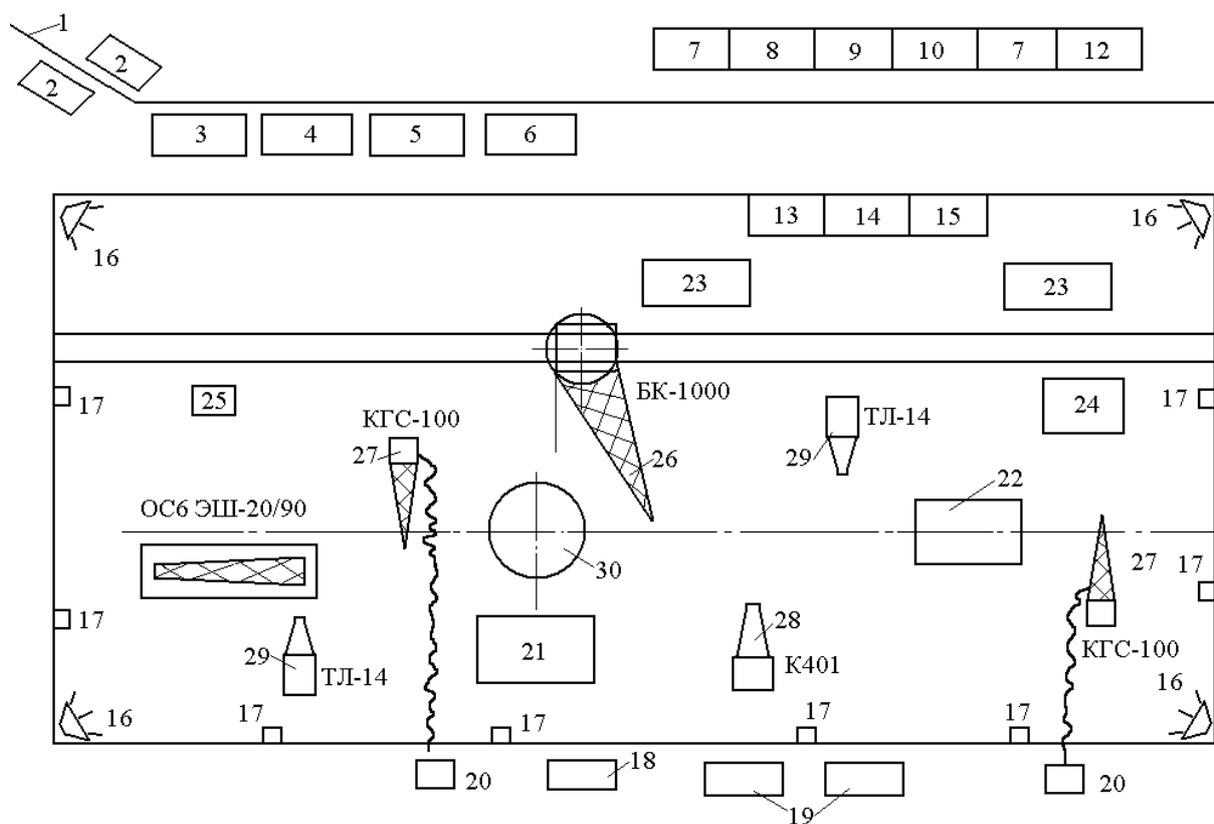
Монтажная площадка Могунского разреза: 1 – ж/д путь; 2 – передвижная котельная; 3 – диспетчерская; 4 – строительное управление; 5, 6 – горные участки; 7 – гараж; 8 – РММ; 9–15 – складские помещения; 16 – осветительные мачты; 17 – сварочные посты; 18 – слесарная мастерская; 19 – складские и бытовые помещения; 20 – электрощитовая; 21, 22 – площадки монтажа хвостовой и передней части поворотной платформы; 23 – площадка для монтажа стрелы; 24 – площадка для хранения крупногабаритных деталей; 25 – пожарный водоем; 26 – кран БК-1000; 27 – кран КГС-100; 28 – кран К401; 29 – трубоукладчики ТЛ-14; 30 – площадка для монтажа базы
